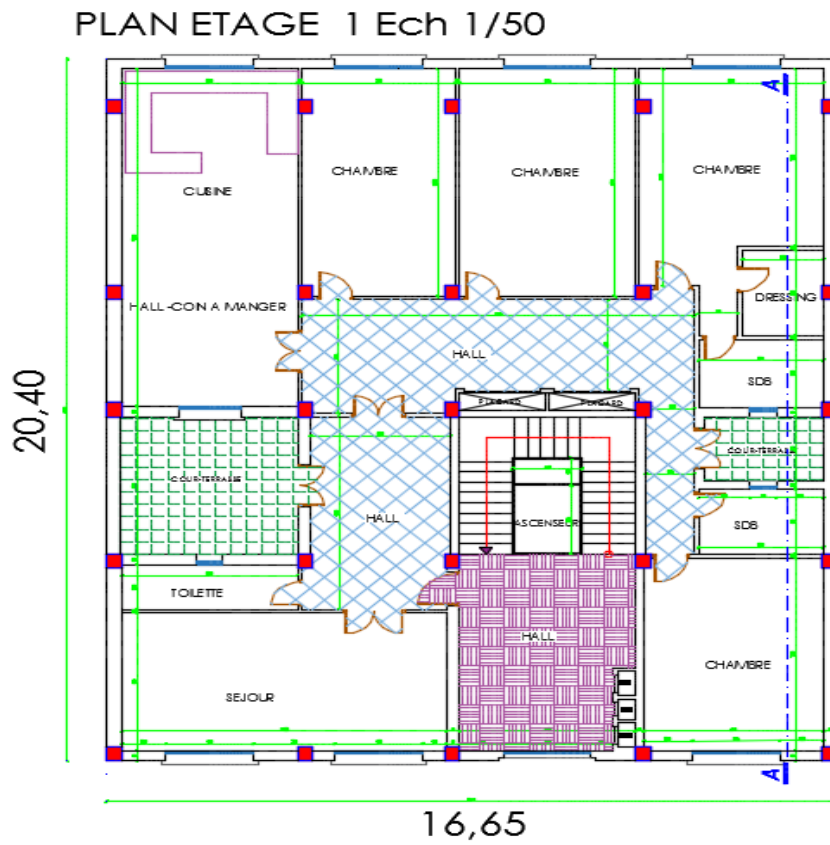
Vue en plan architectural d'une tour RDC +S/SOL+ 12 Etage
